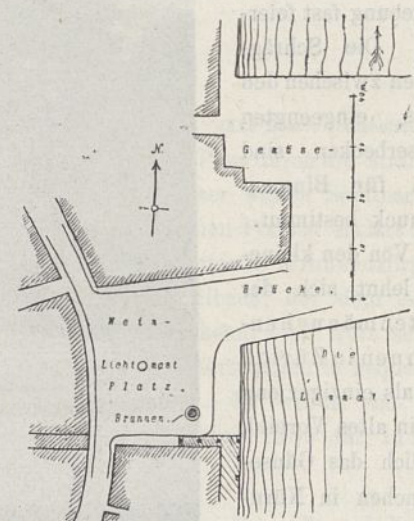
Zürich, Brunnen auf dem Weinplatz. Lageplan.
